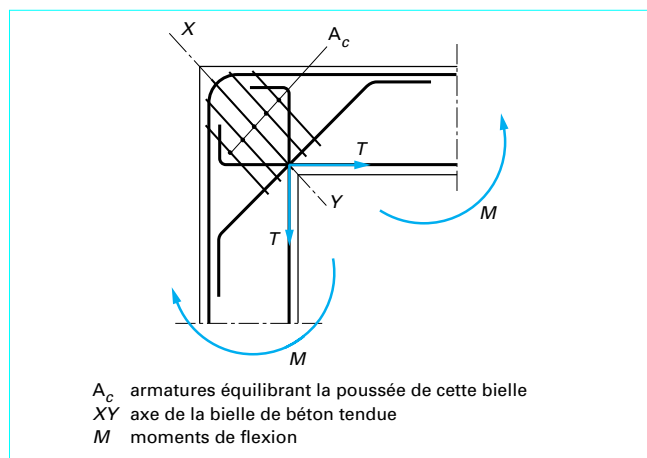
Armatures d'un nœud de portique intensément sollicité
